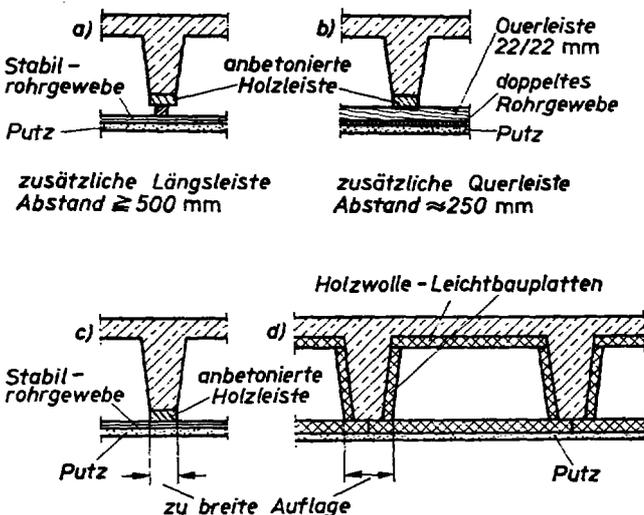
bis 6d. Befestigung von biegeweichen Unterdecken an Plattenbalken- oder Stahlbeton-Rippendecken
